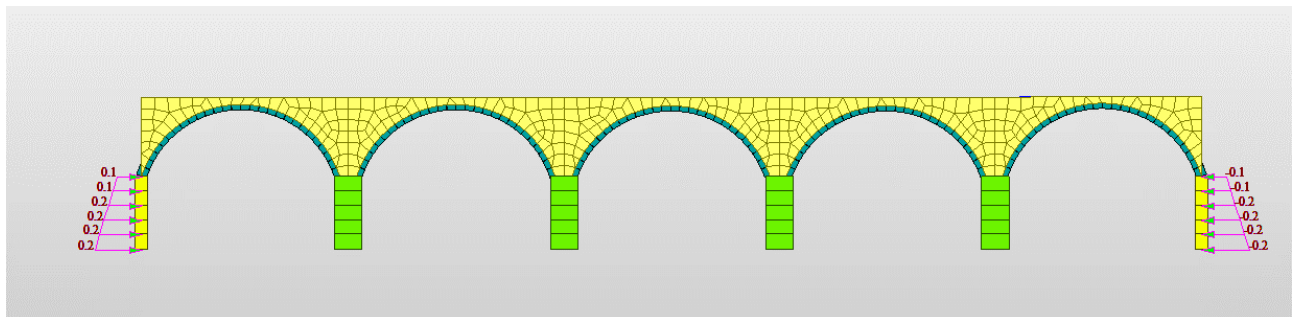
Carico dovuto alla spinta statica della terra agente sulle spalle
